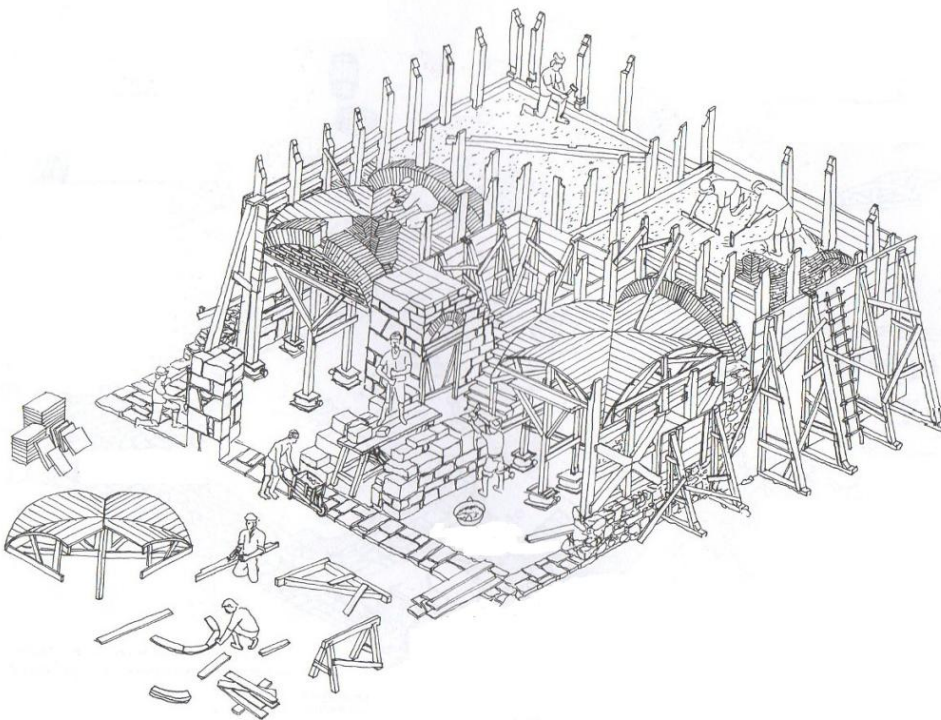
Construção do piso térreo (Mascarenhas, 2004).
